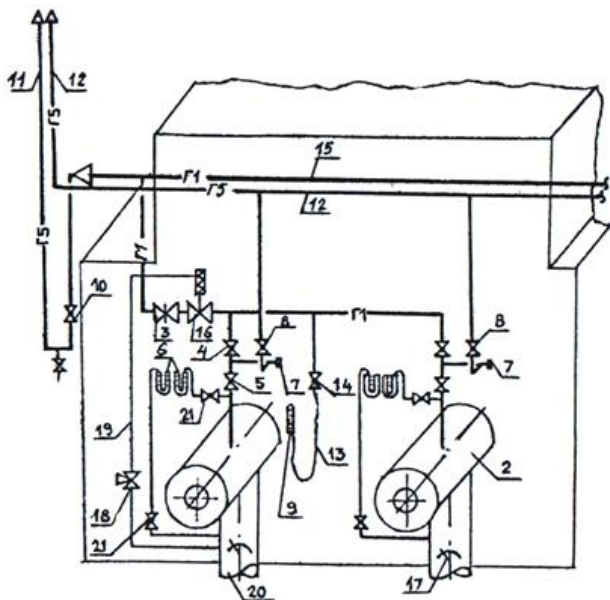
Схема обвязки агрегата со смешивательными горелками:
